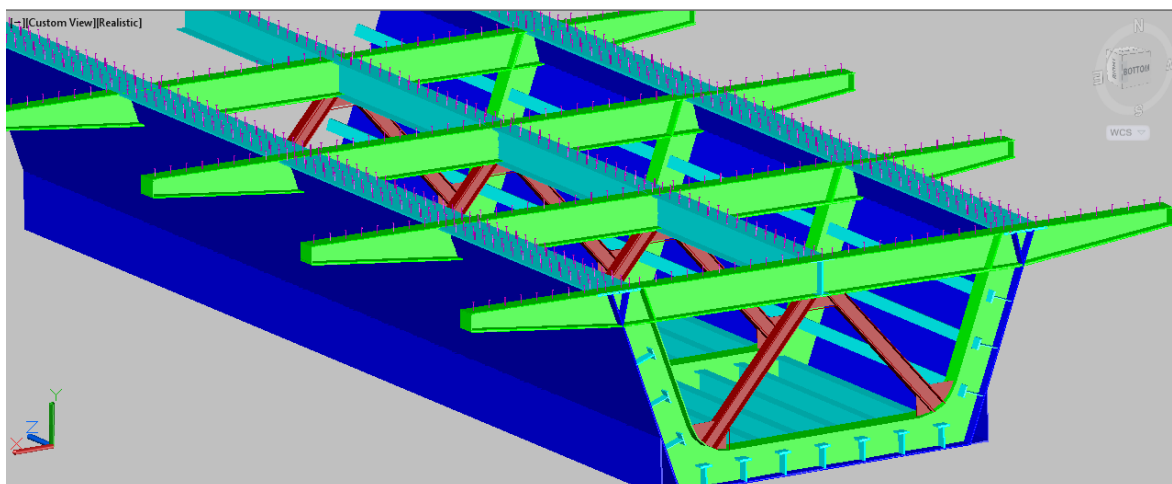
Ilustración 3D del cajón metálico (Fuente: Elaboración propia)
